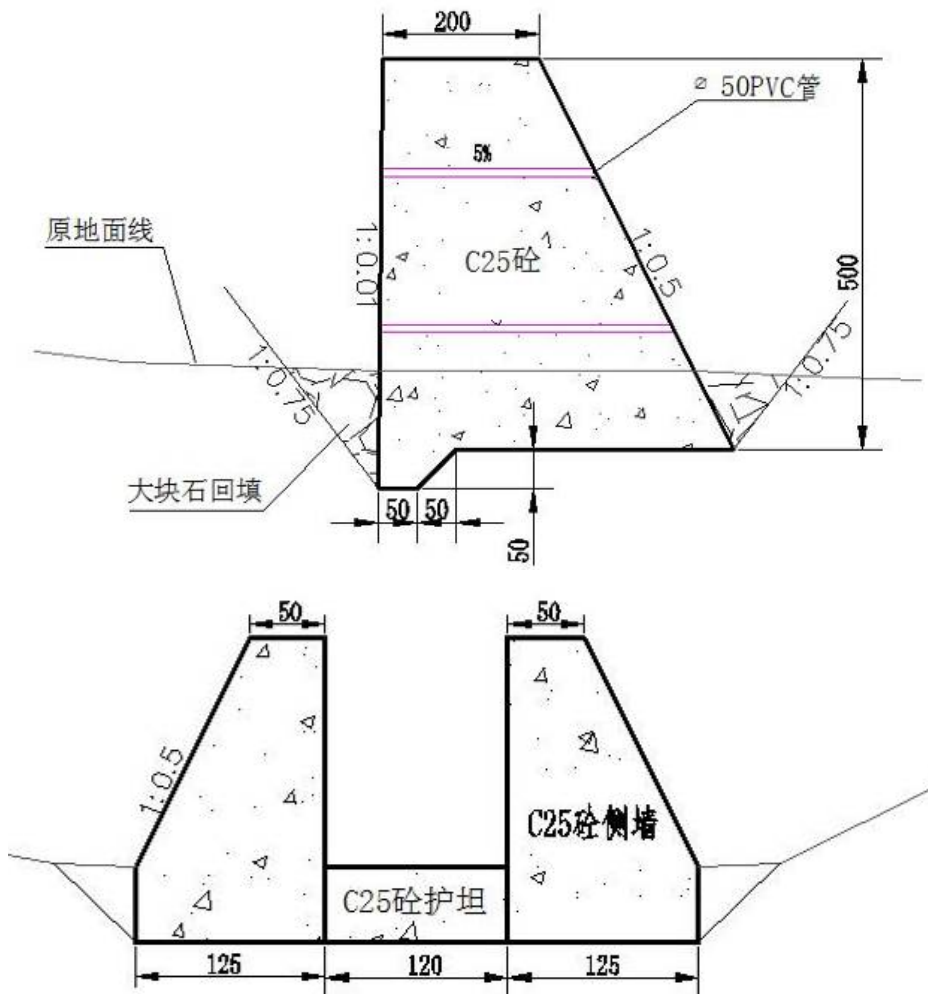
拦砂坝和消力池断面图 (单位: mm)
